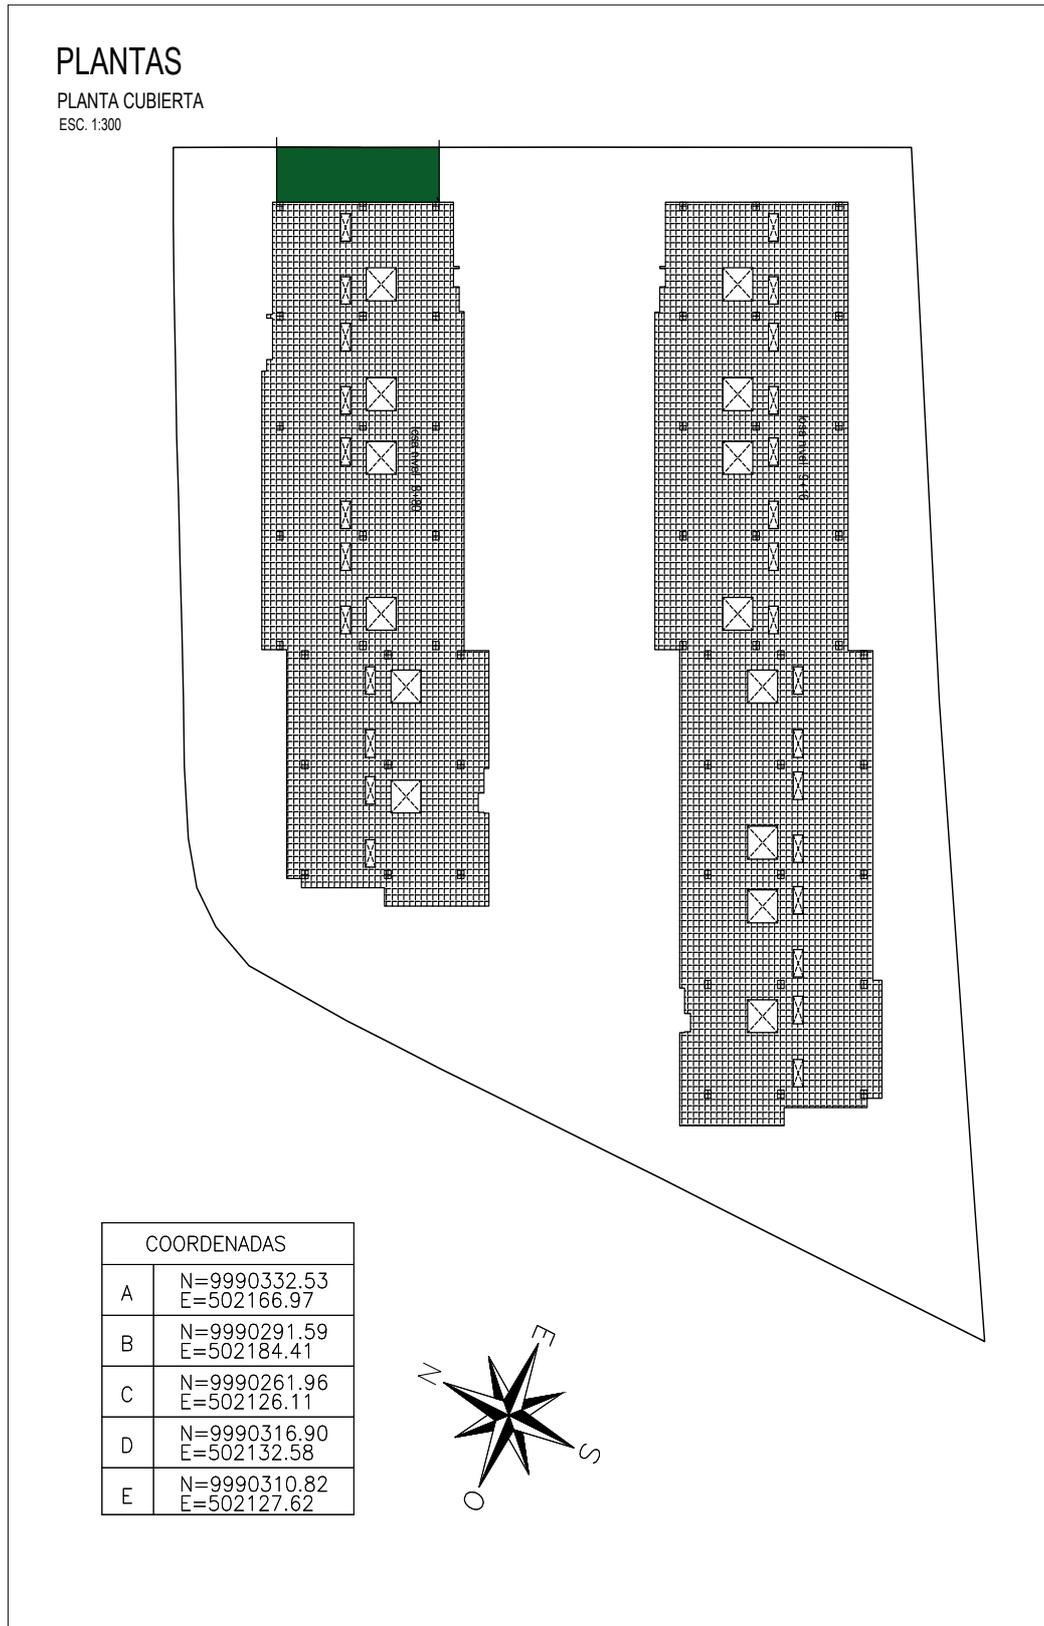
Vista en Planta Las Brizas; Elaborado por: David González
